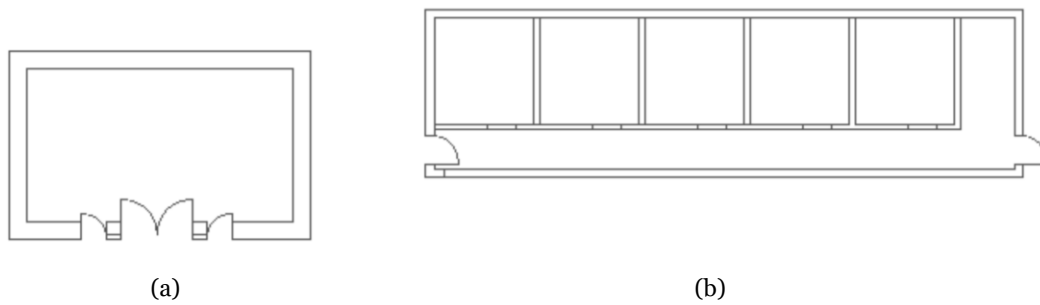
Casa Quinta da Lage: (a) Planta de Piso -1; (b) Planta de Piso 0; Sem Escala.
